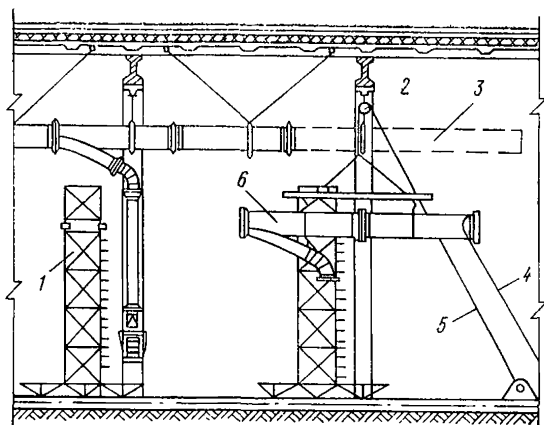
Схема монтажа воздуховодов промышленной вентиляции
